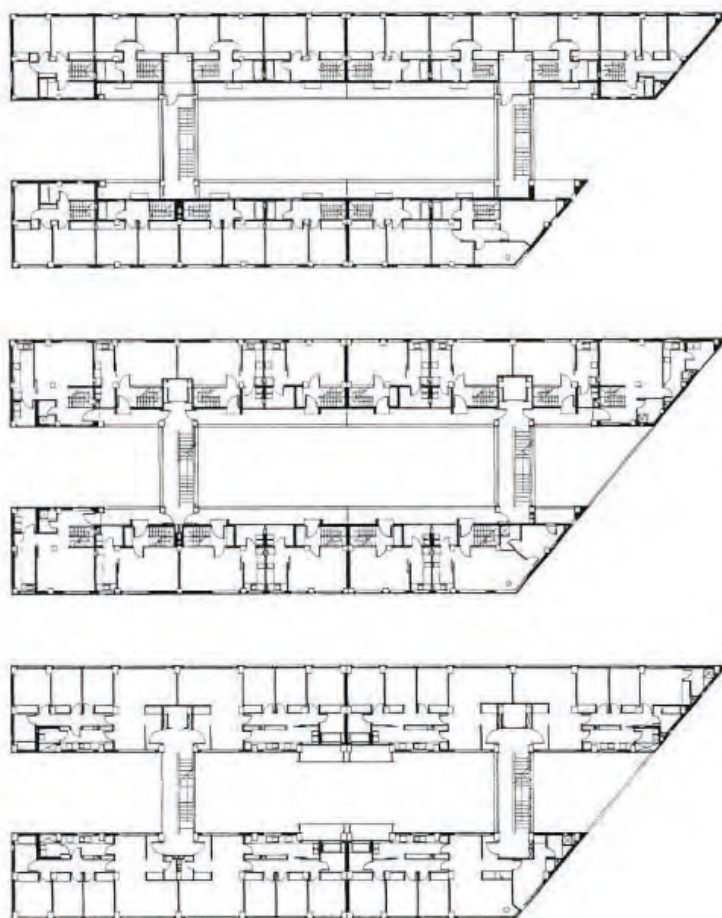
Lola Alonso Vera. *Viviendas de Protección Oficial en la calle Santo Domingo, Alicante*, 1990-93. Planta tipo (abajo), planta inferior dúplex (centro) y planta superior dúplex (arriba).
